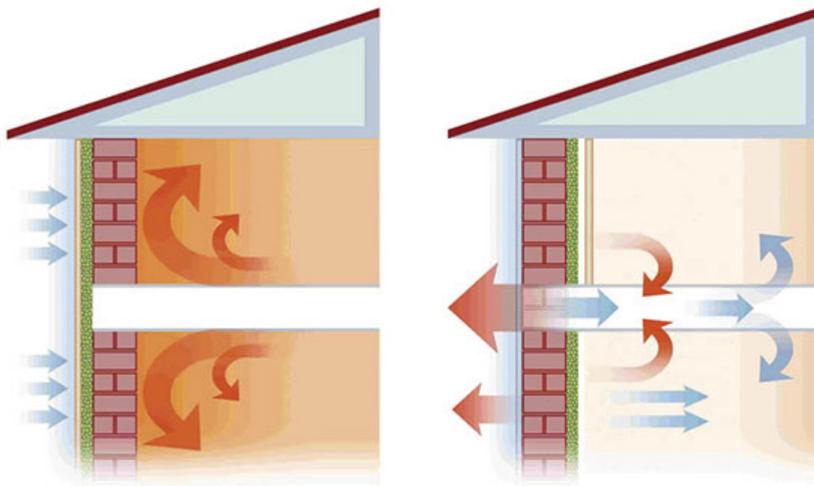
Esquema explicativo de pérdida térmica en fachada con aislante exterior y con aislante interior. [www.tectónica.com](http://www.tectónica.com)
